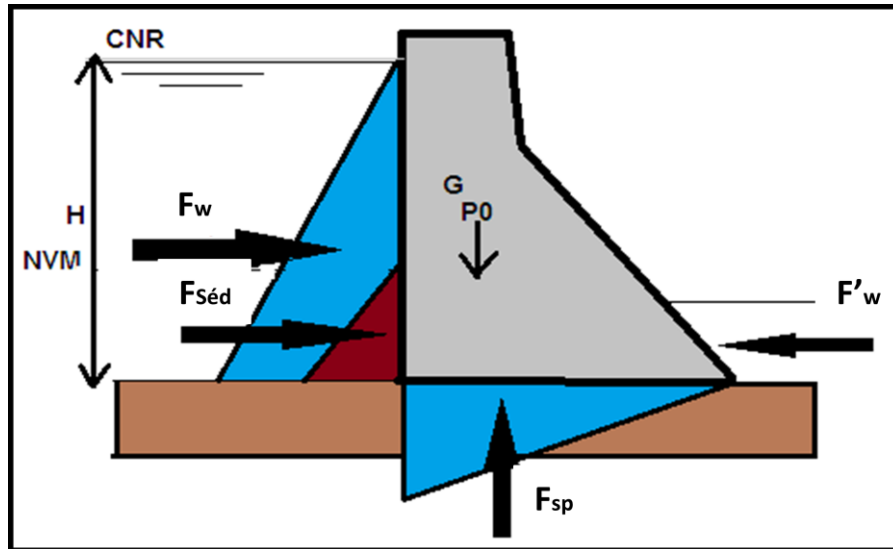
Forces agissantes sur la stabilité d'un barrage poids.
